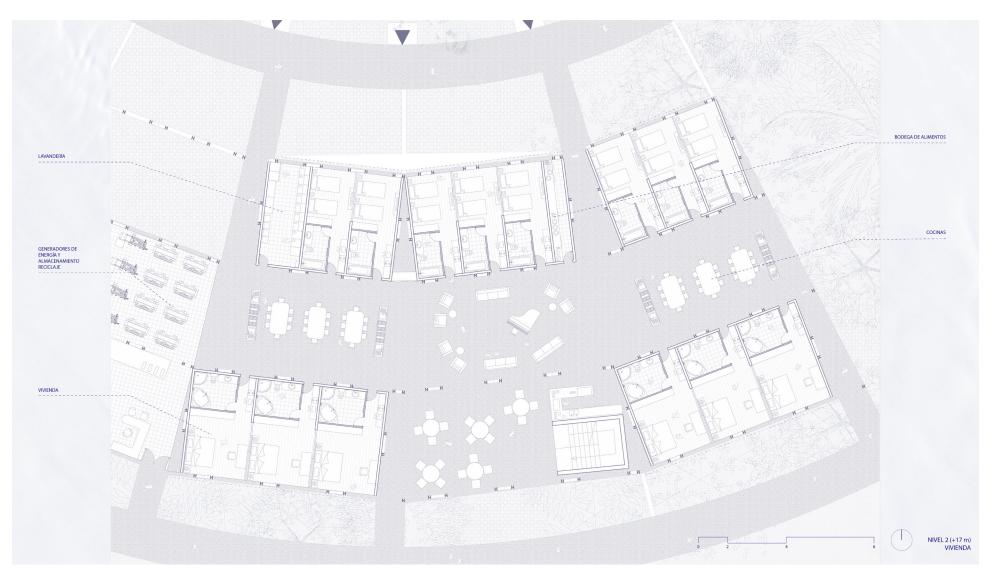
Detalle de planta nivel 2, vivienda, Elaboración propia, 2021.
